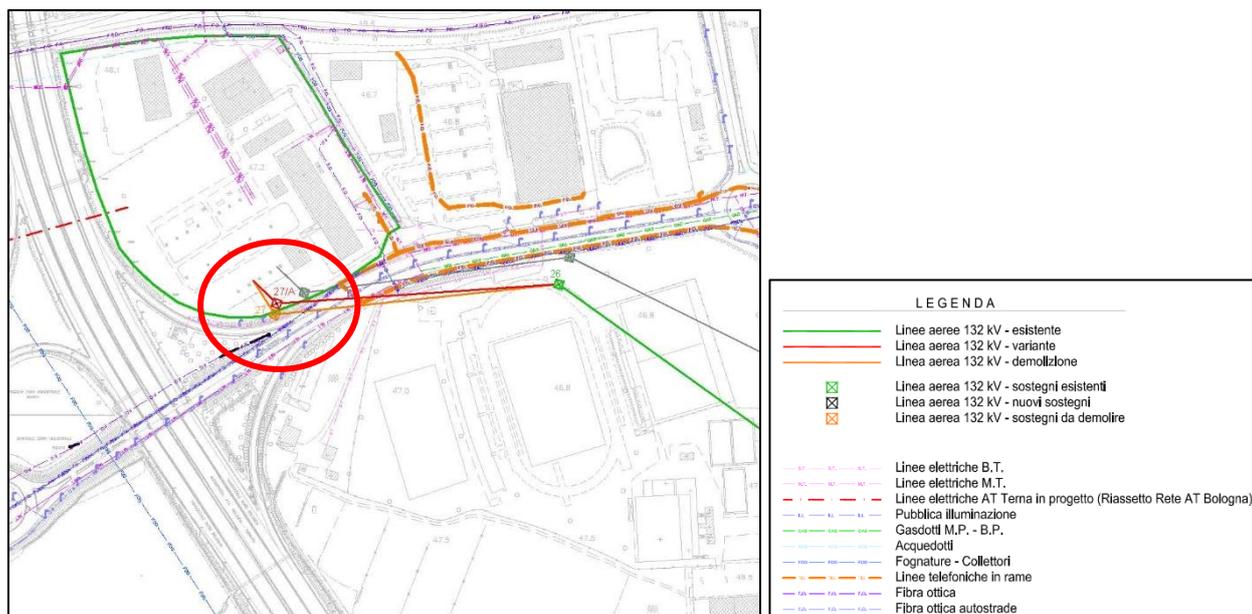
Planimetria di progetto nuovo sostegno 27A.
